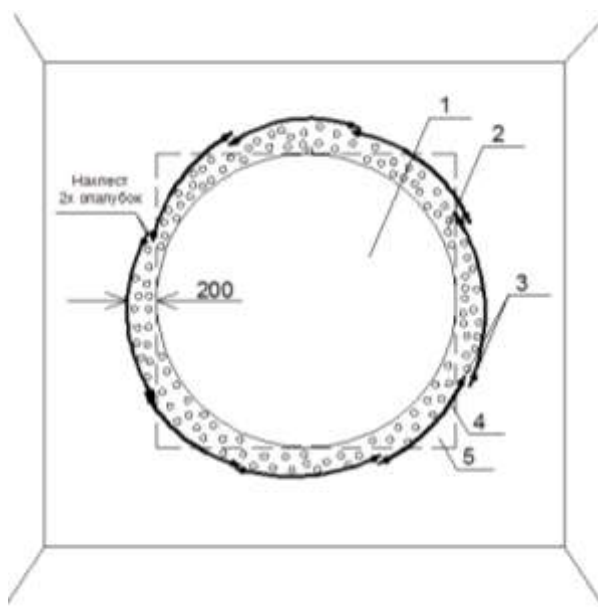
Установка набора скользящих опалубок вокруг резервуара. Вид сверху.
